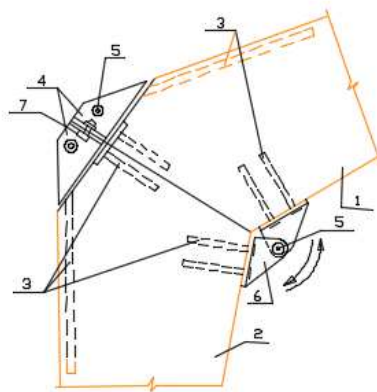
Карнизный узел сборно-разборной рамы (ЦНИИСК): 1 – ригель; 2 – стойка; 3 – вклеенные стержни; 4 – металлические башмаки; 5 – валики; 6 – шарниры; 7 – стяжной болт
